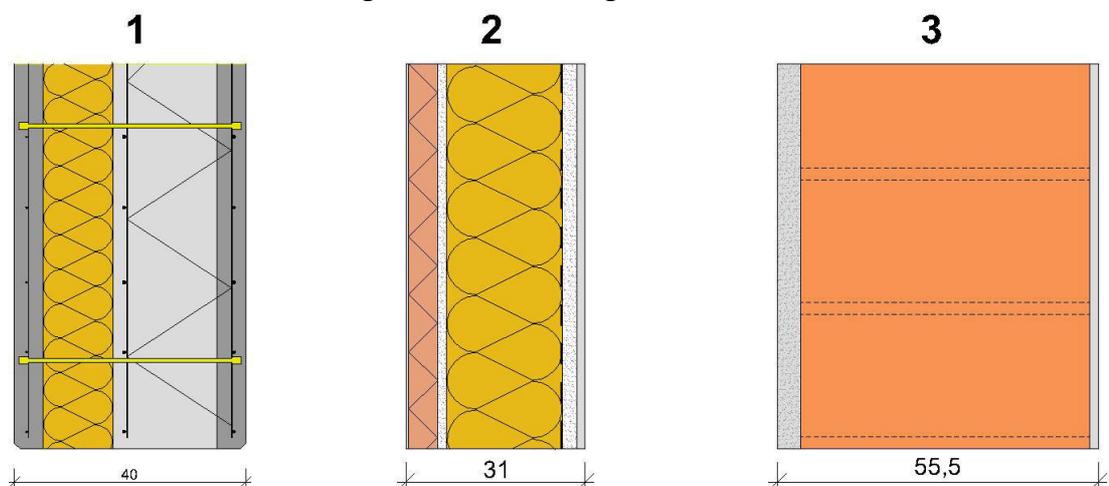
Übersicht der gewählten Wandaufbauten: 1) Betonbauweise in PROGRESS Thermowand®, 2) Holzbauweise als Holzrahmenbau, 3) Ziegelbauweise aus Mauerwerk in Hochlochziegeln (6)
